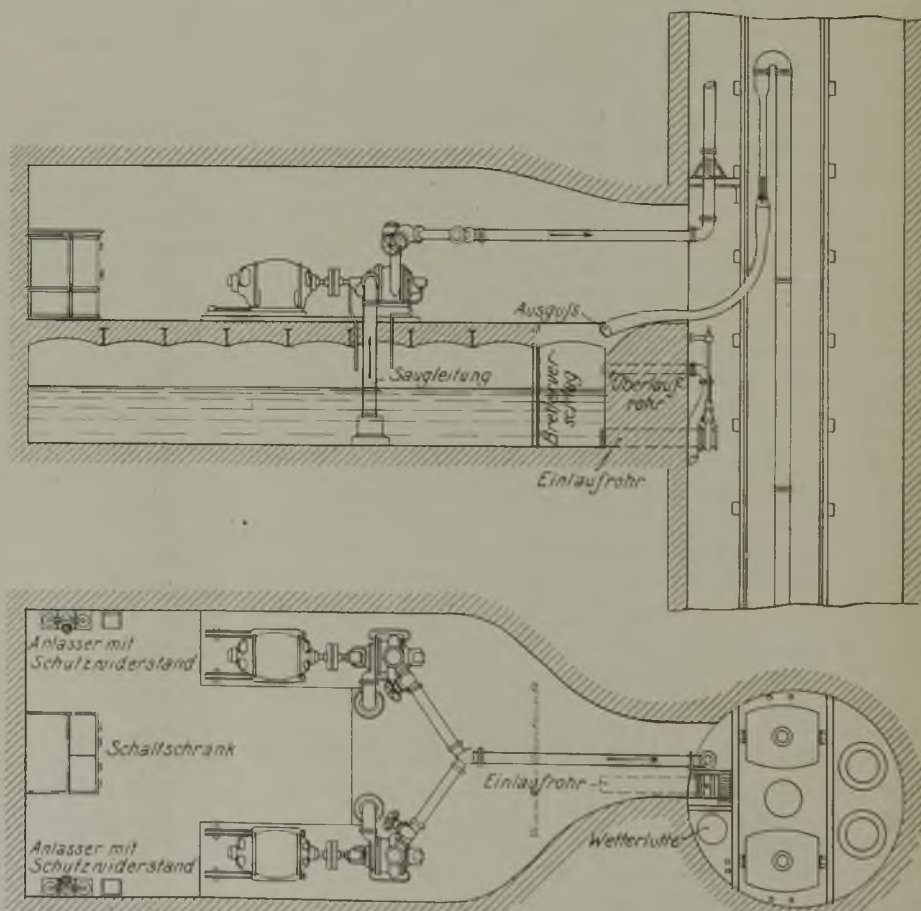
Längsschnitt und Grundriß der Pumpenkammer.
